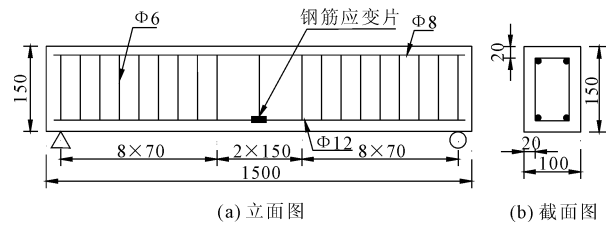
陶粒混凝土梁构造及配筋(单位:mm)
